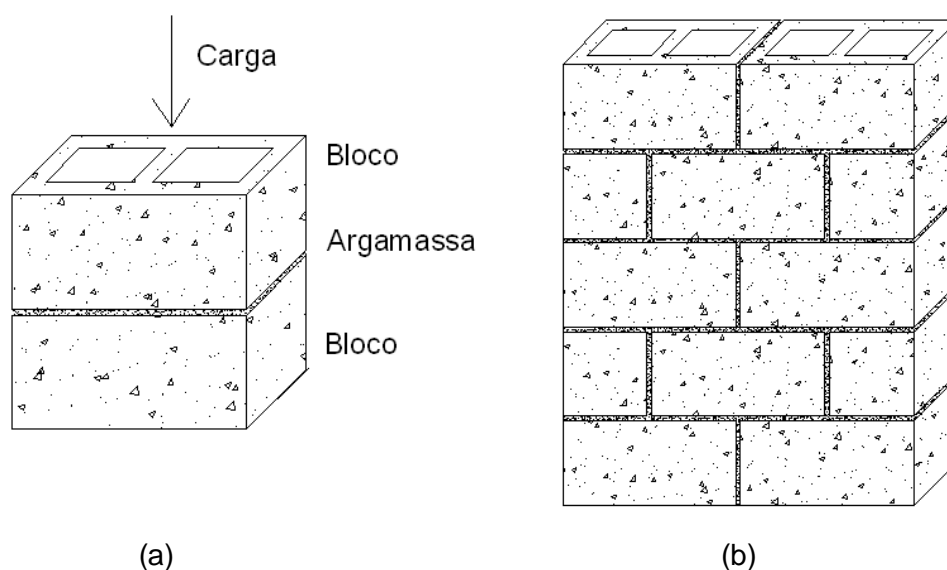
Prisma (a) e mini-parede de bloco de concreto (b)
